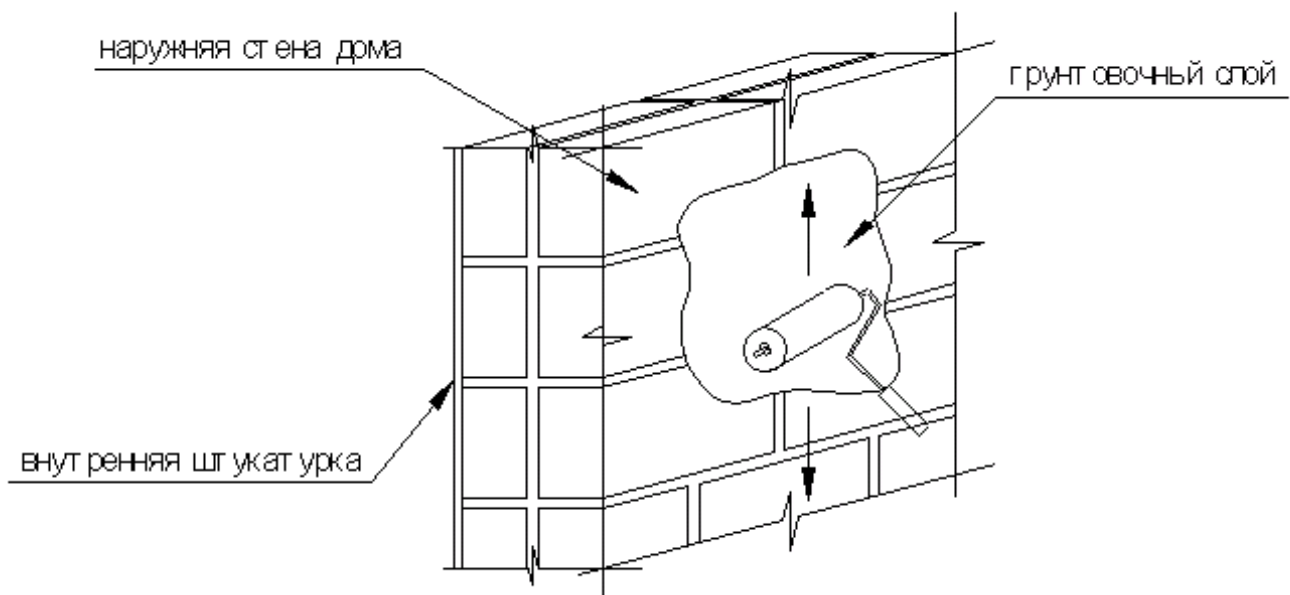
Нанесение грунтовки на наружную поверхность стены
